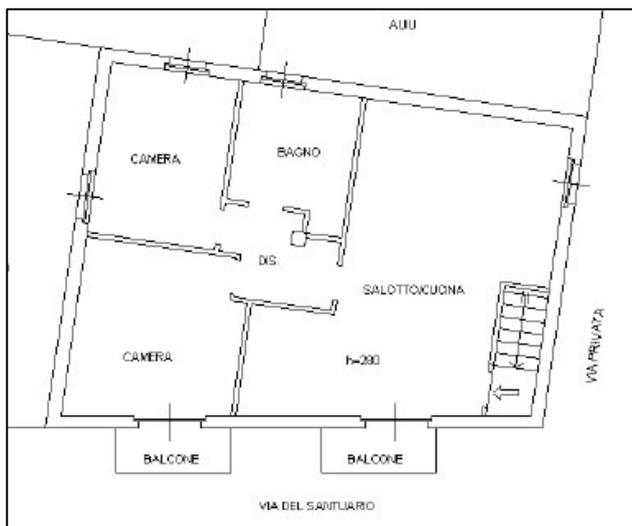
Planimetria catastale sub. 4 del 28.07.2010
